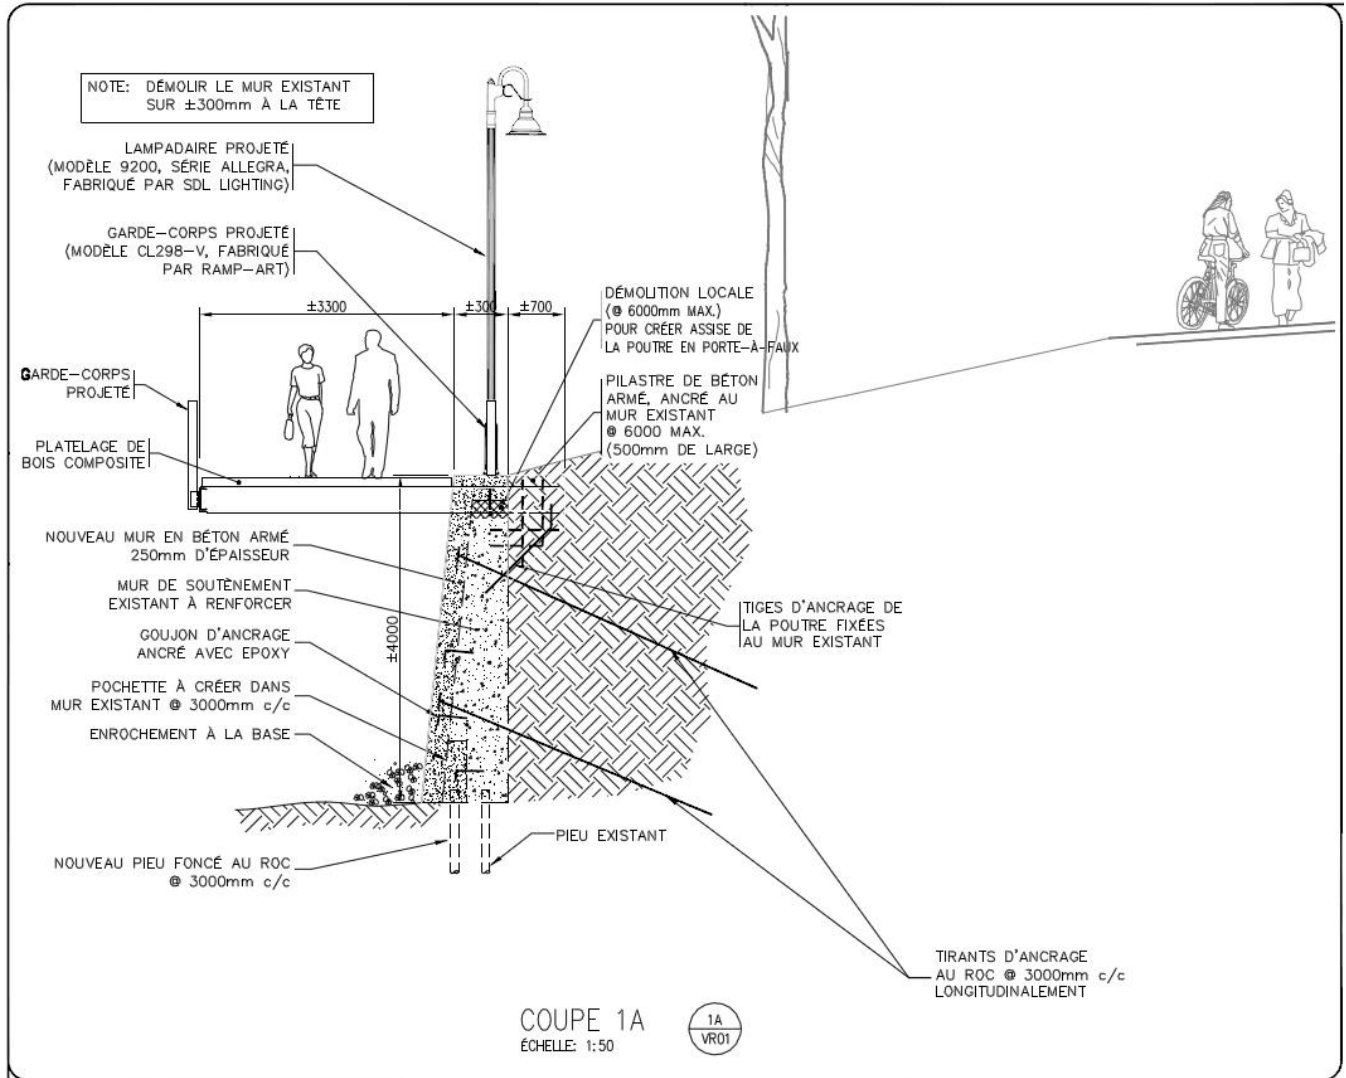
Vue en coupe des travaux de renforcement du mur existant sur les 30 premiers mètres du tronçon 1 (Source : Génipur, 2015).
